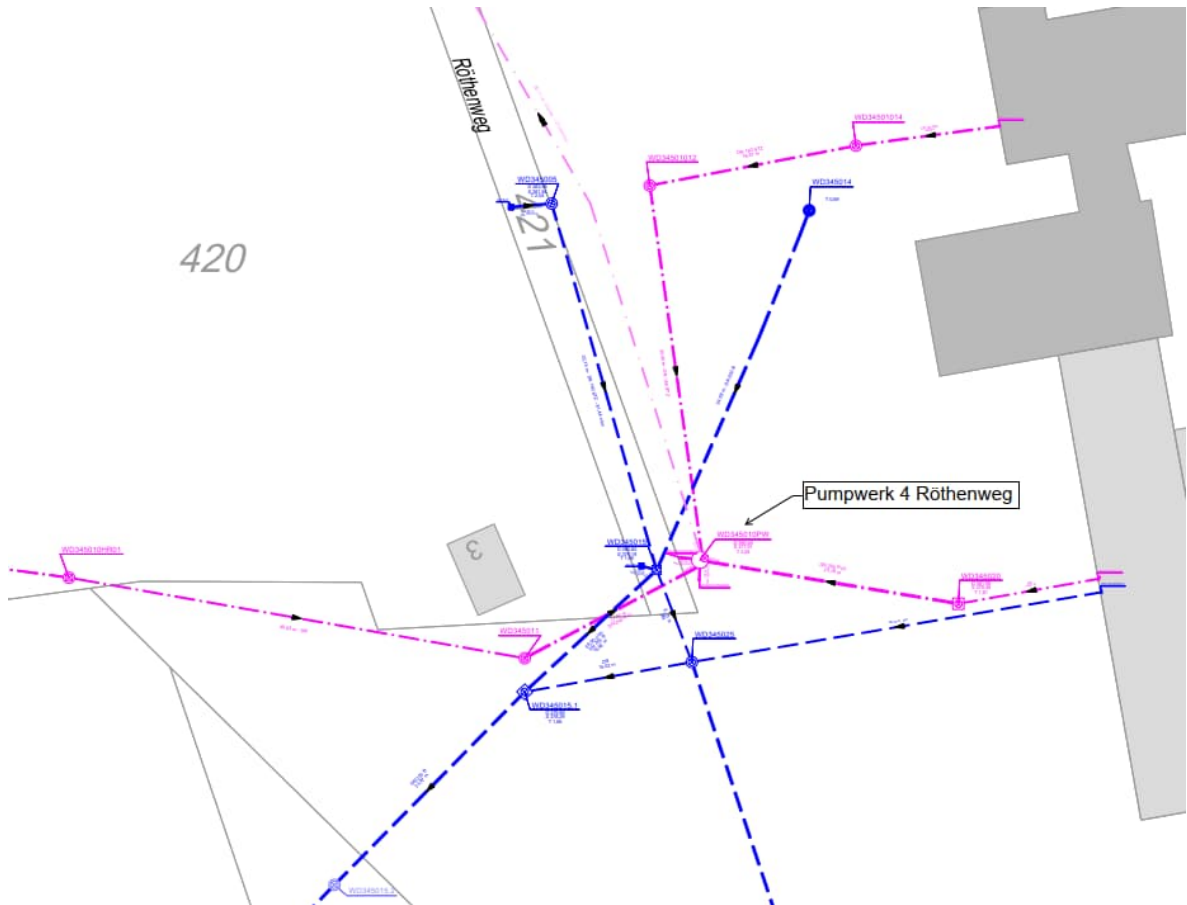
Lageplan Pumpwerk 4 Weidach Röthenweg
